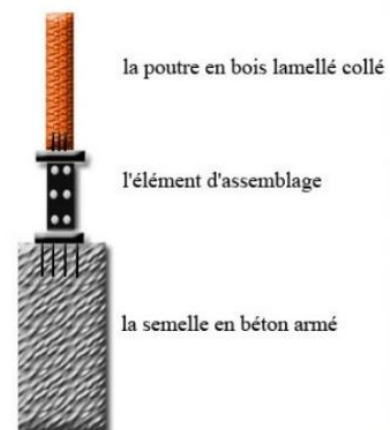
assemblage poteau en bois lamellé collé et fondation en béton armé
